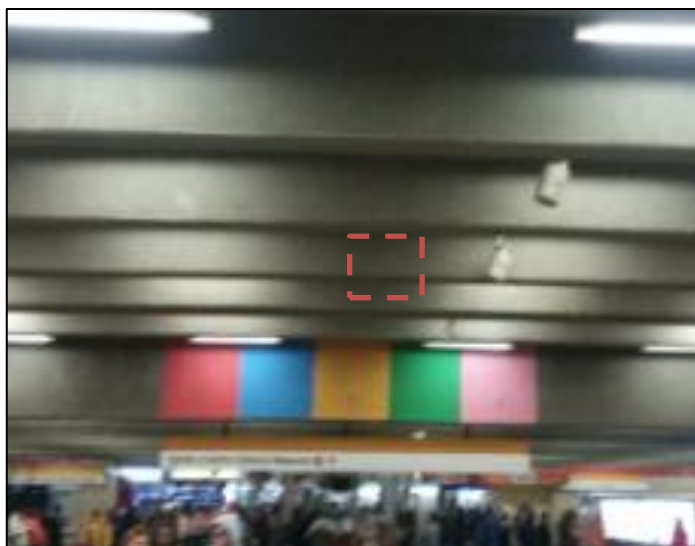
En Techo en Viga Horizontal en Pasillo
